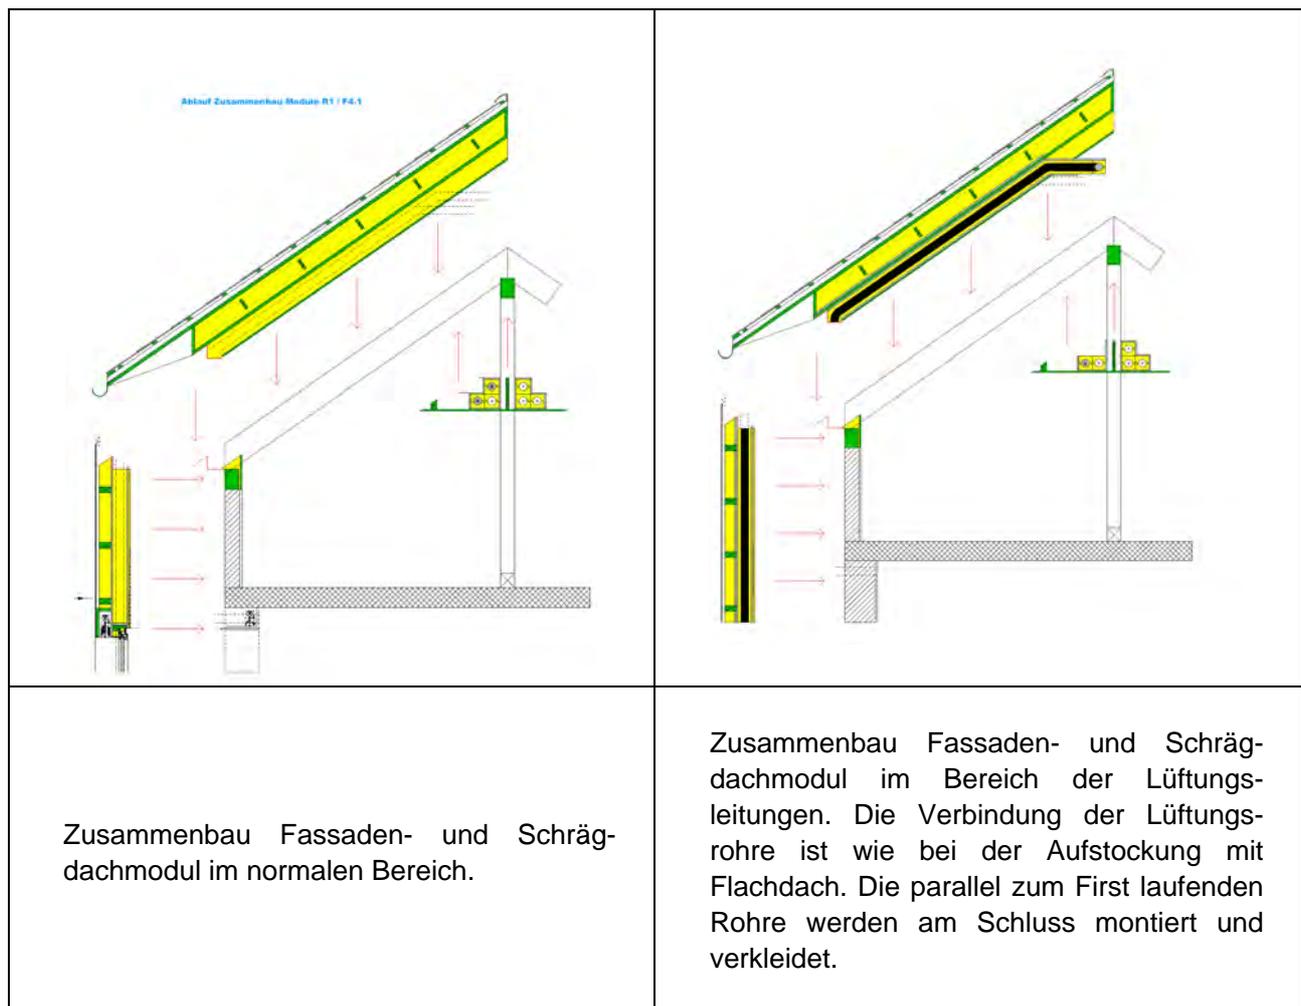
Zusammenbau Fassaden und Dachmodul, bei wiederverwendeter Pfetten-Sparrenkonstruktion
